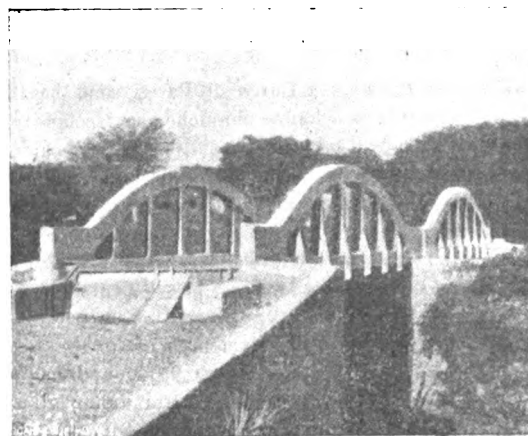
Ponte in cemento armato di Las Minas. - Vista.
